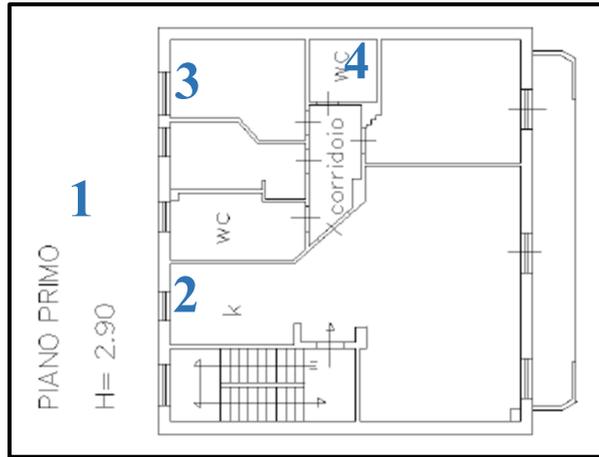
Stralcio planimetria catastale Piano Primo
